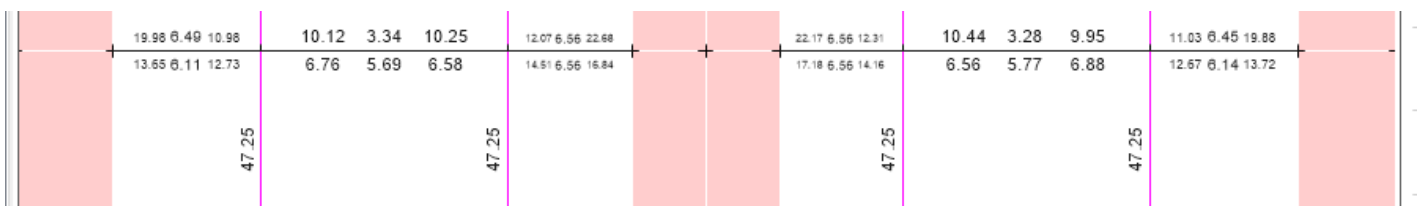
Acero Requerido por momentos en Vigas 3° Piso
